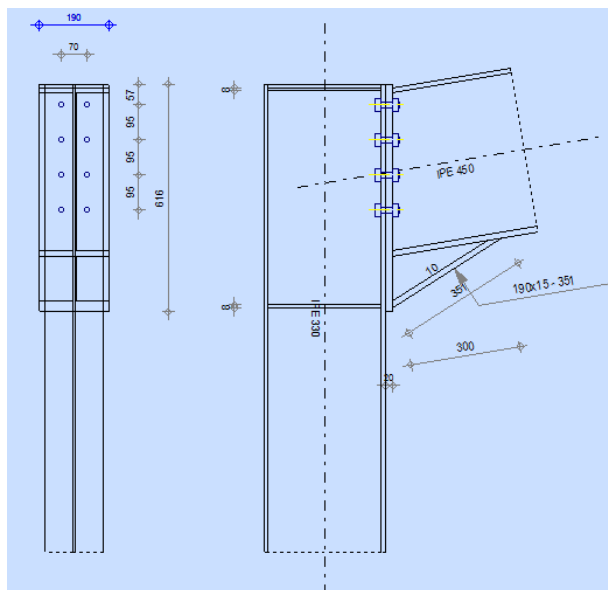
Schéma d'assemblage (poteau-traverse)
